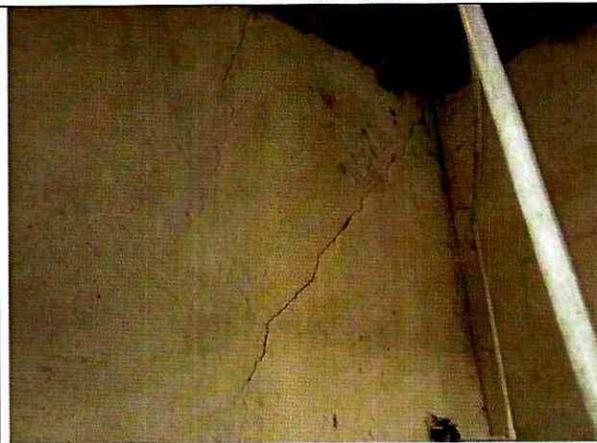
Fisuras y grietas en muros de primer piso.
